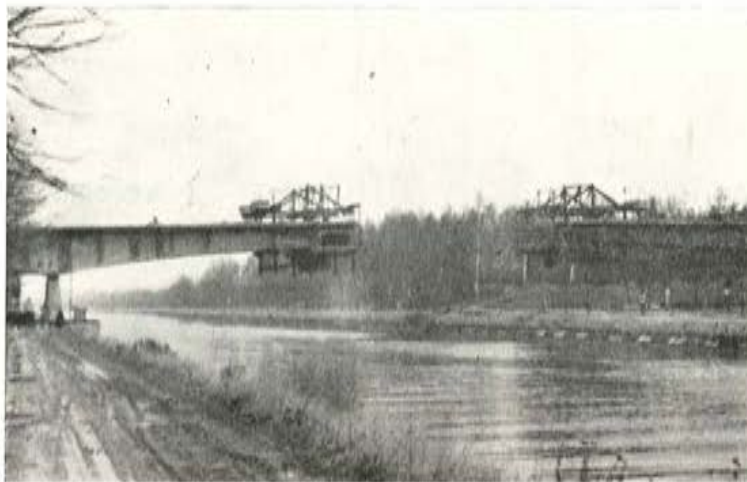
Puente de Eigenbilzen. Vista durante la construcción.
